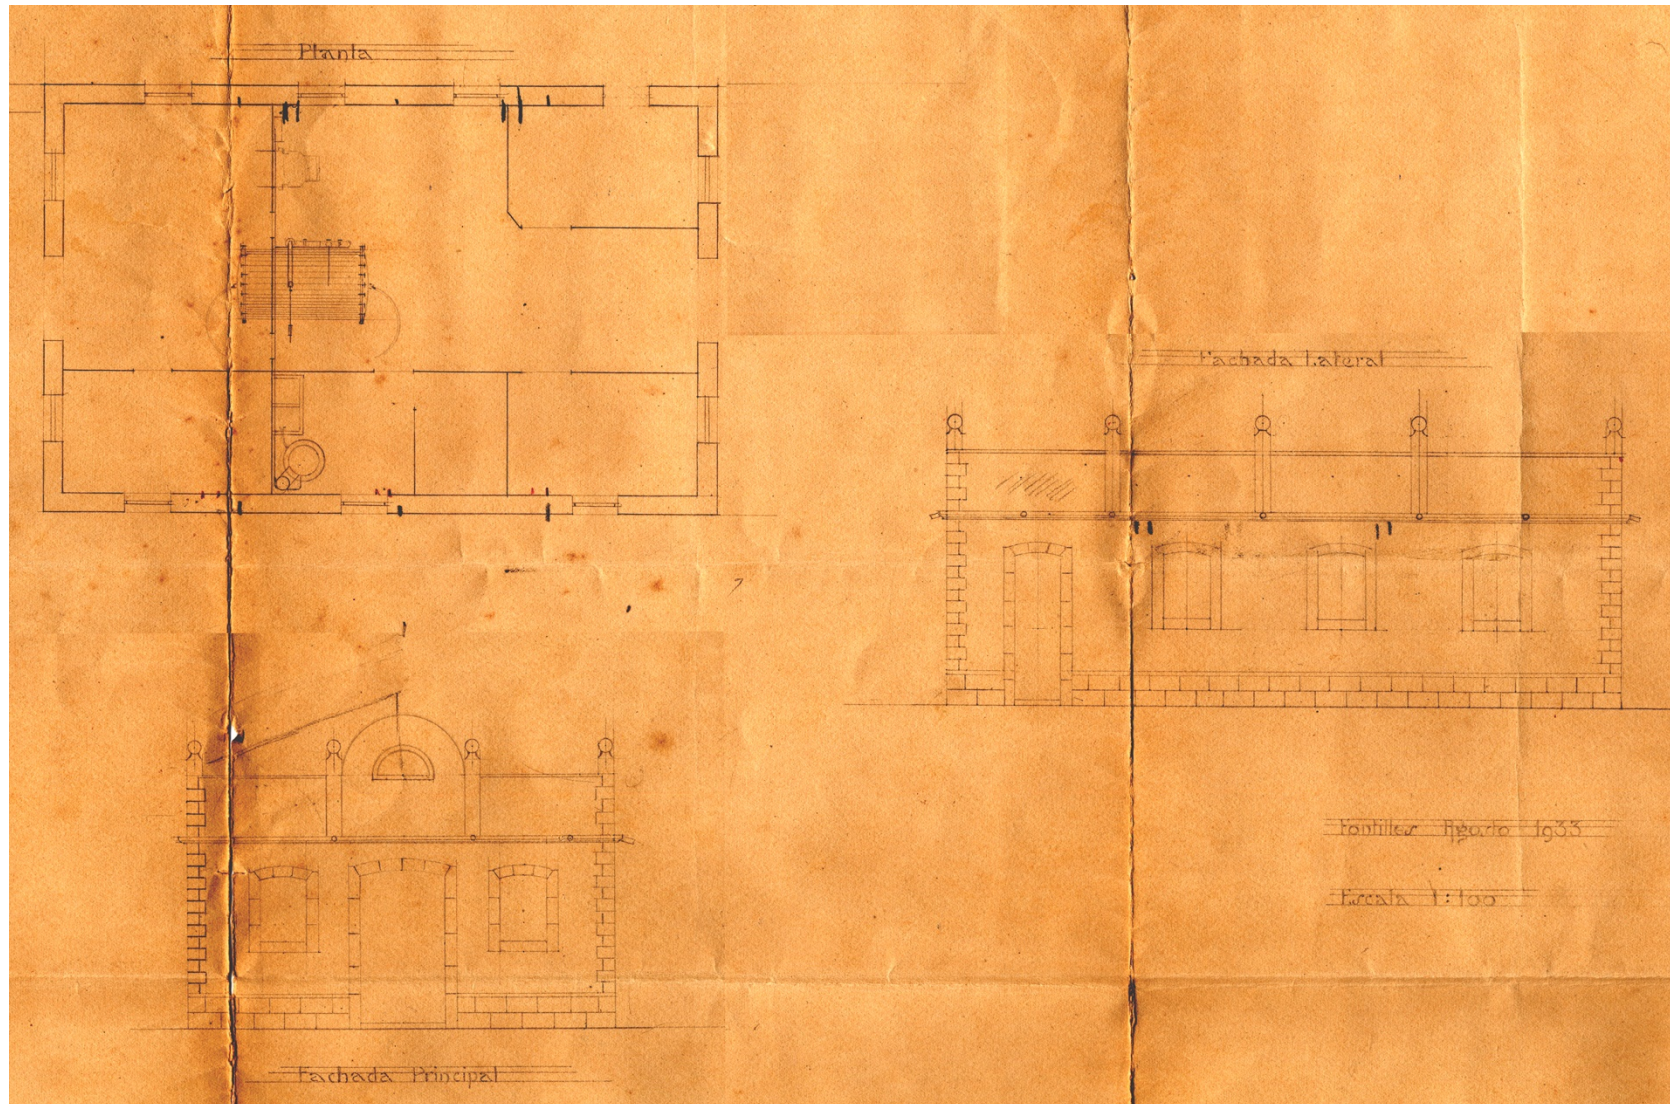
Levantamiento planimétrico del Pabellón de Desinfección, atribuido al Arquitecto Juan Vidal Ramos. Agosto 1933. Sanatorio Leprosería Nacional Fontilles.<sup>492</sup>
